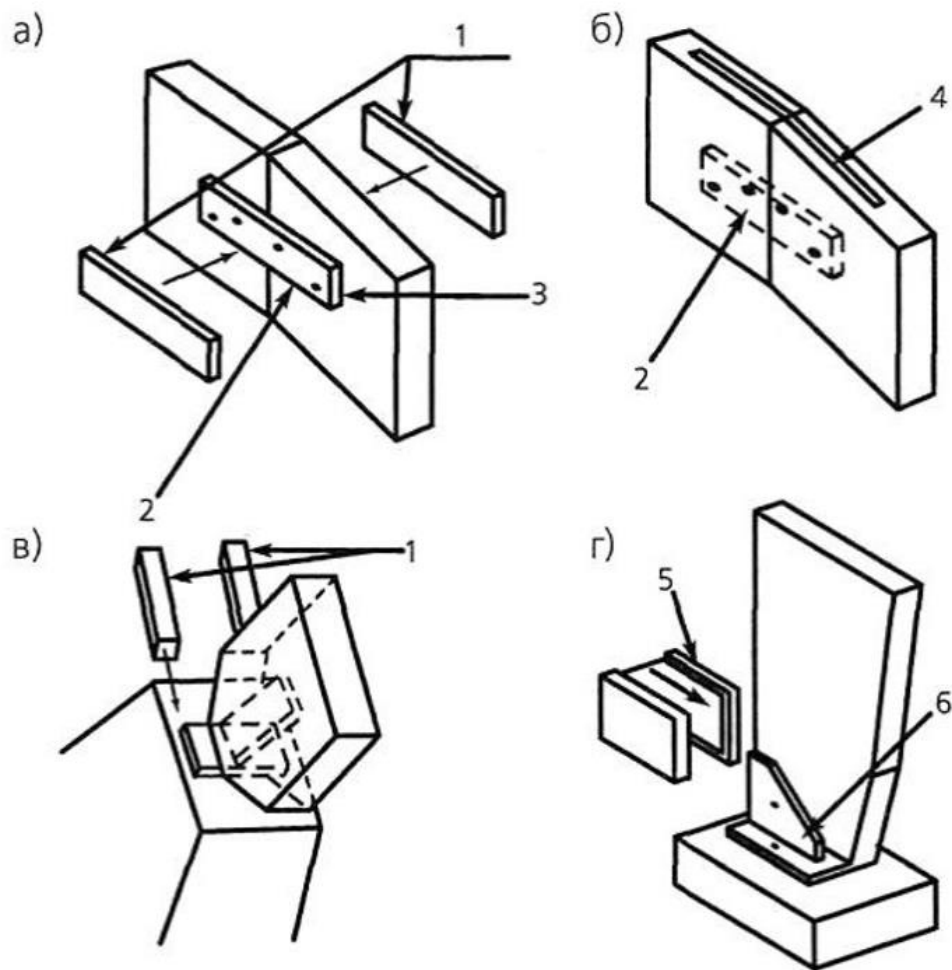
Конструктивний вогнезахист вузлів клеєних дерев'яних конструкцій: а, б - конькового вузла, в - опорного вузла арки, г - опорного вузла рами; 1 - захисні накладки; 2 – ста-лева накладка; 3 - прокладка; 4 - проріз; 5 - захисний чохол; 6 - сталевий черевик
